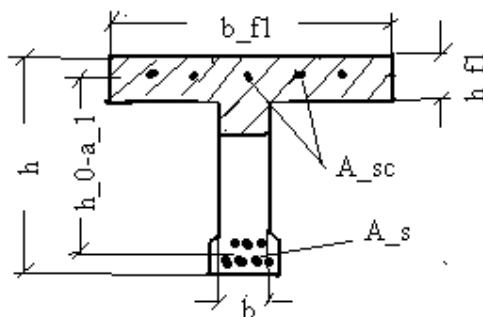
Расчетная схема железобетонного изгибаемого элемента с тавровым сечением и арматурой в сжатой зоне
